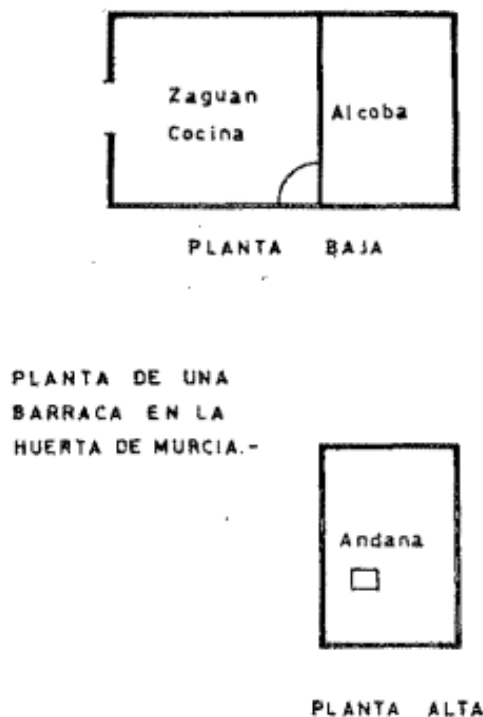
/ 8: Planta baja y planta alta / andana de barraca murciana.
